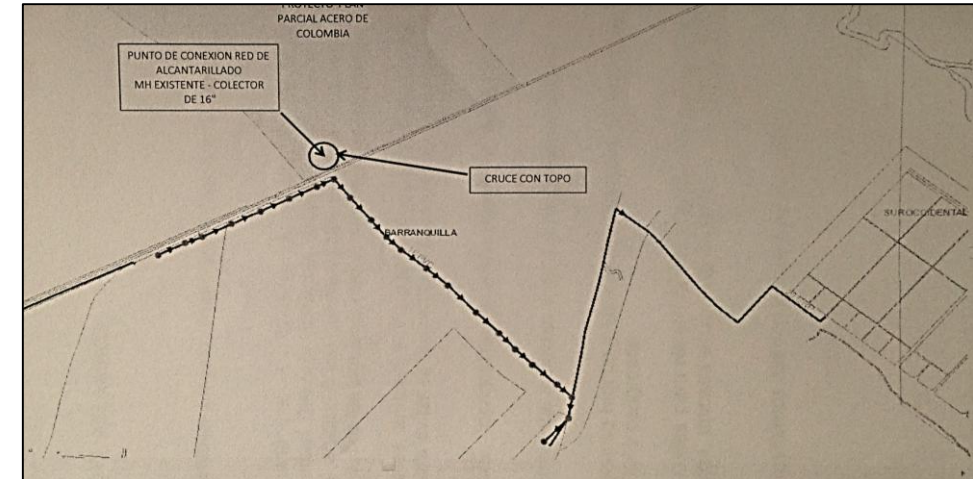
Localización Punto de Conexión Red de Alcantarillado.
